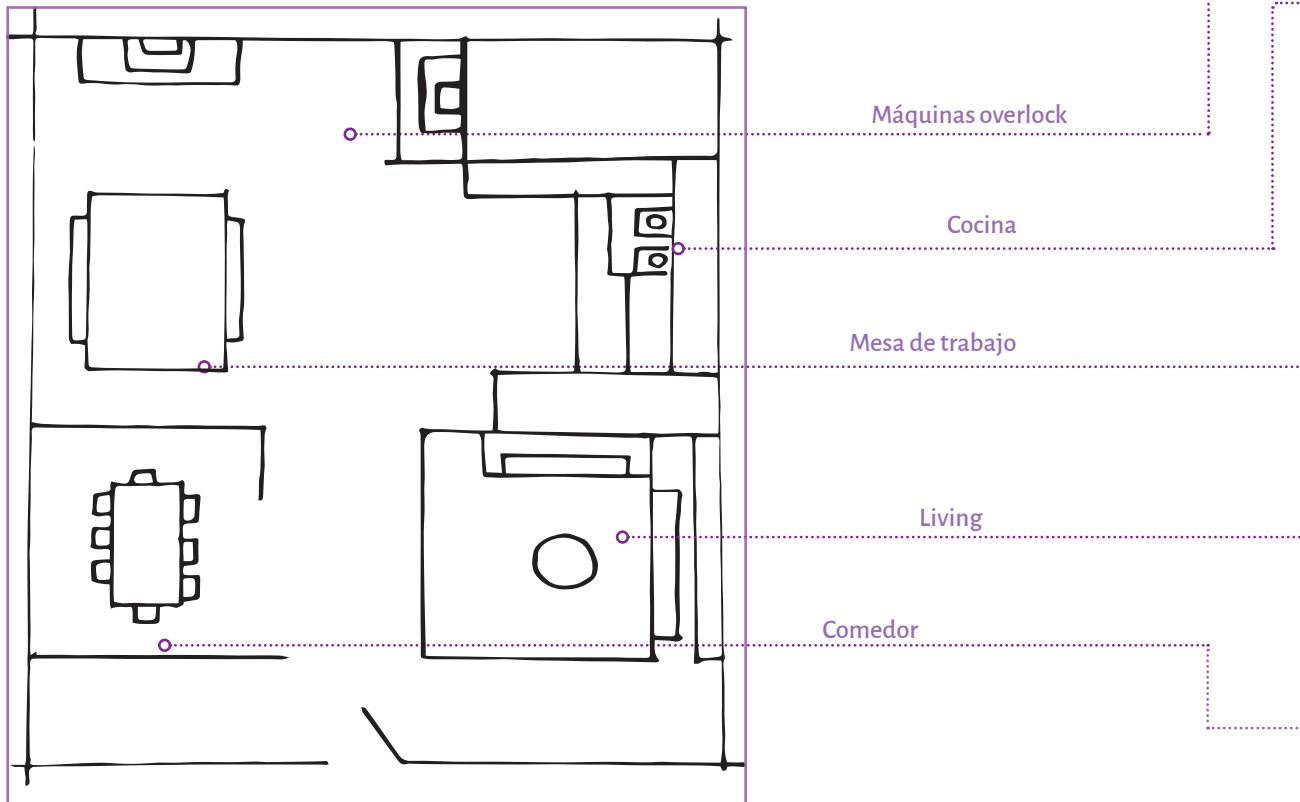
Boceto. Planta baja de la casa de Rosa Millaqueo.
